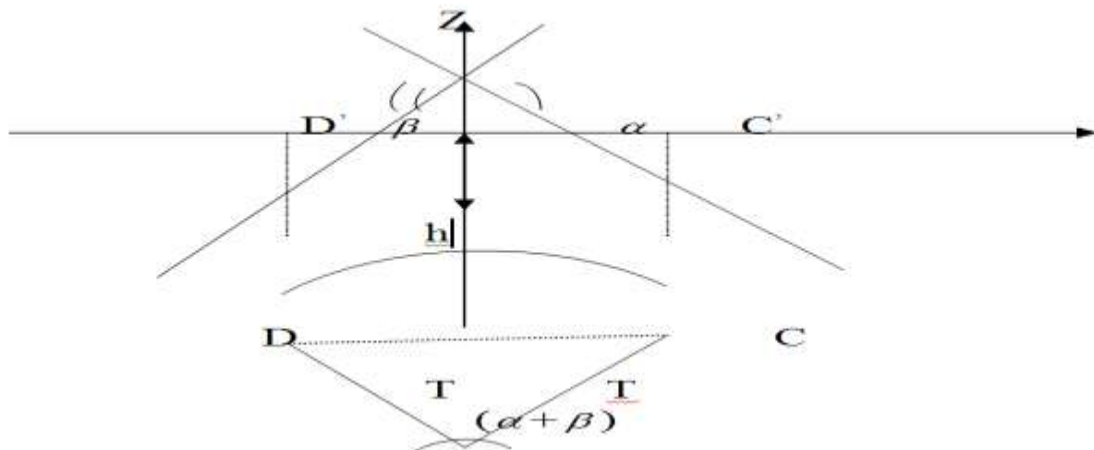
ELEMENTS NECESSAIRES DU PROFIL EN LONG
